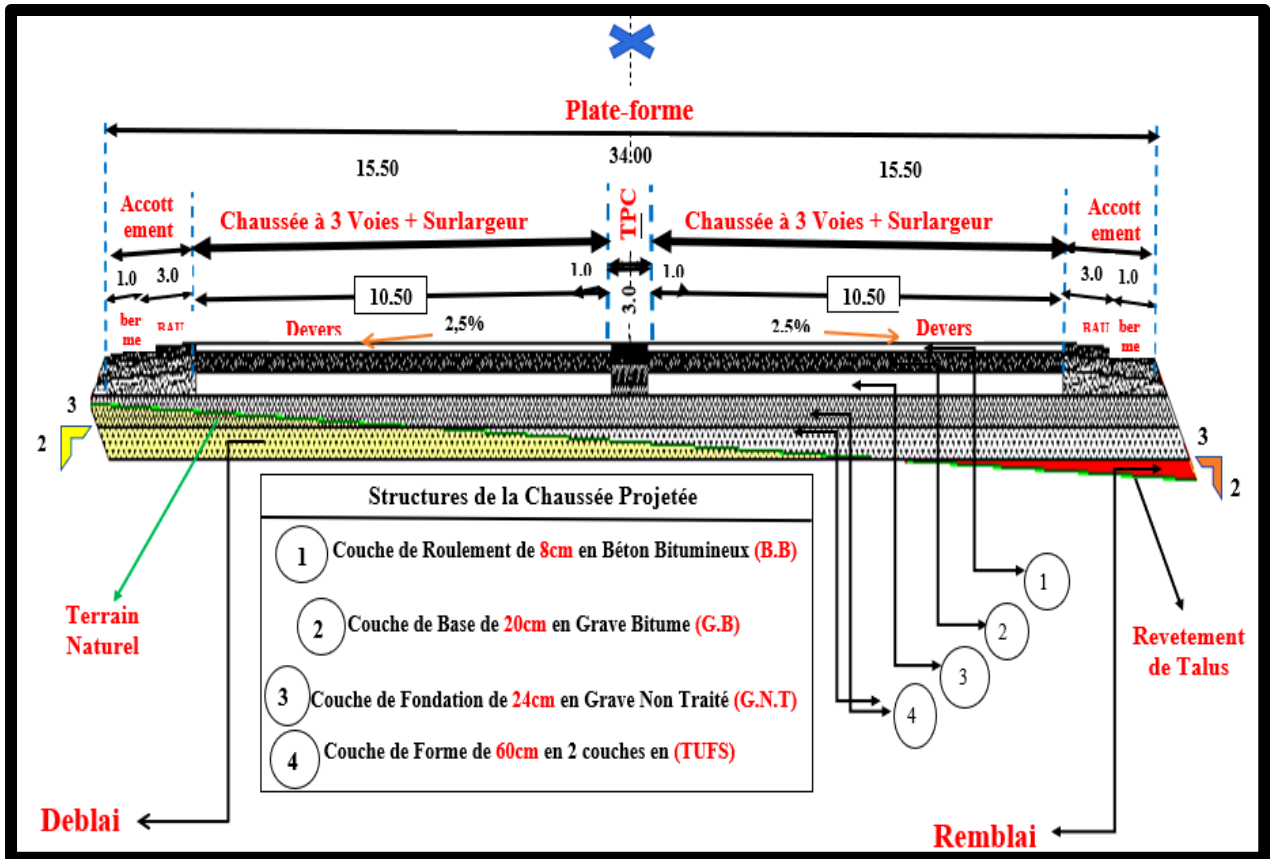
Profil en Travers Type de la Liaison – Autoroutière Tiaret-Relizane
